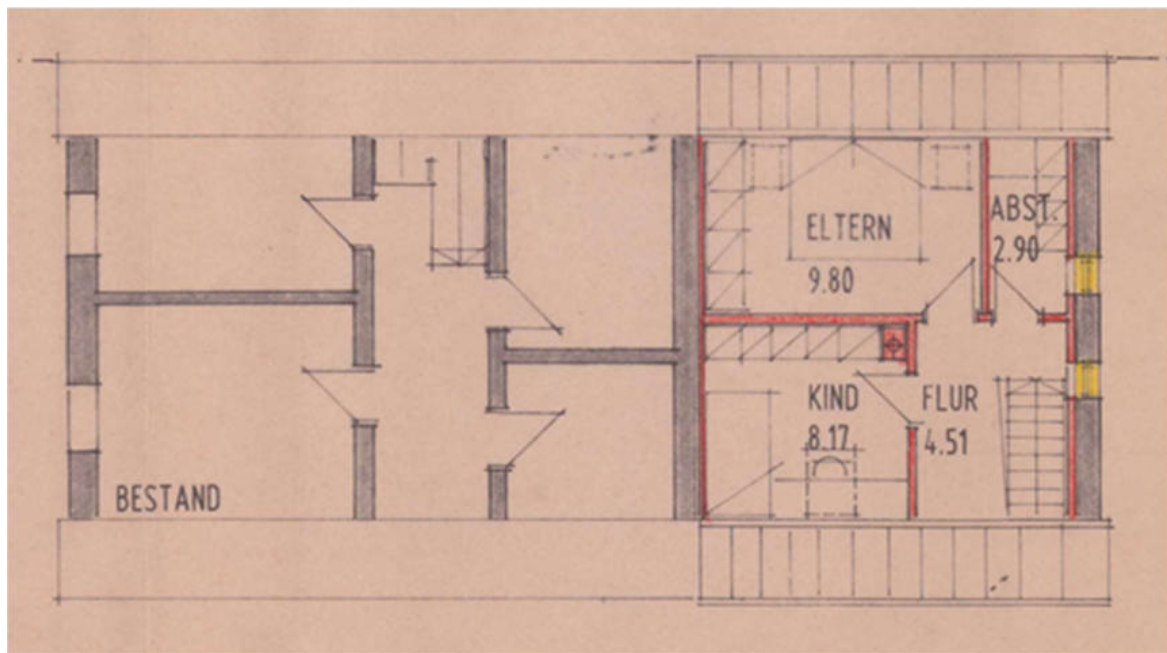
Grundriss Dachgeschoss (Umbau Scheune zu Wohnhaus 1993)
